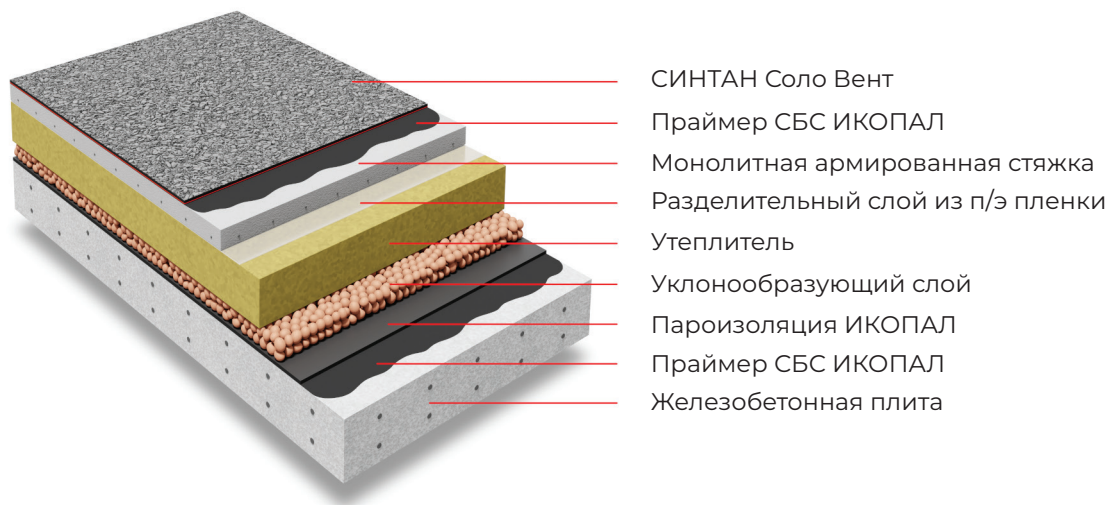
Вариант неэксплуатируемой вентиляруемой кровли с однослойным кровельным ковром
